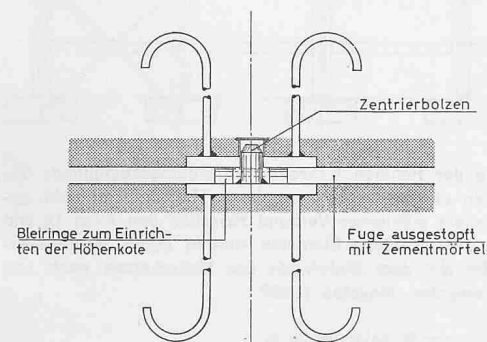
Detail B: Auflagerplatten mit Zentrierbolzen und Bleiringen zum genauen Einpassen der Stütze (siehe Bild 22). Masstab 1:15
